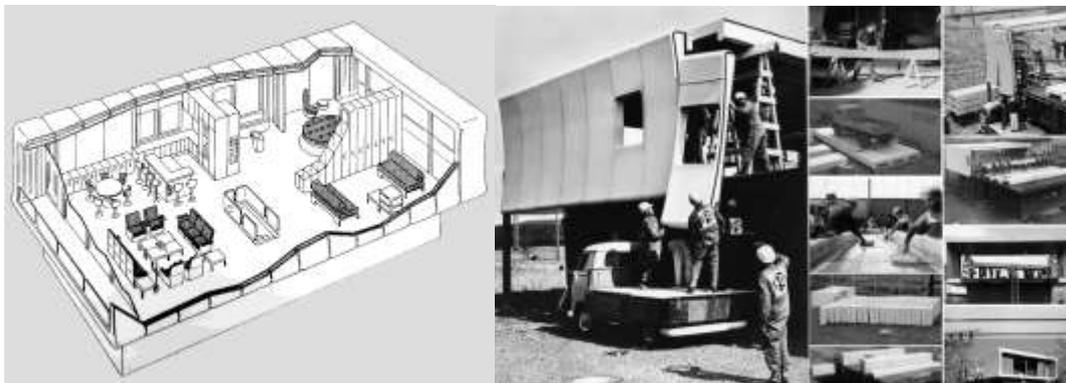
Kunststoffhaus: a) Axonometria do interior; b) Fases de montagem da estrutura modular em fibra de vidro (Disponível em: <http://modmom.blogspot.pt/2011/04/prefab-fiberglass-house-kunststoffhaus.html>).
